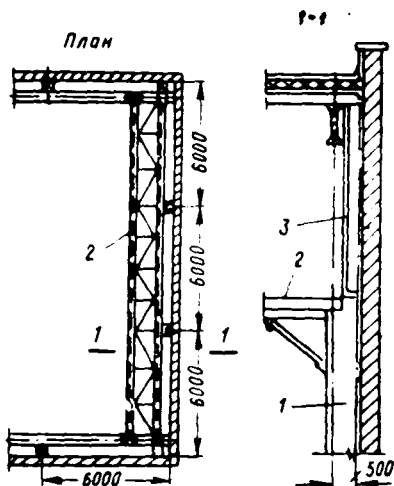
Схемы горизонтальных стальных связей в торце здания на уровне подкрановых балок
